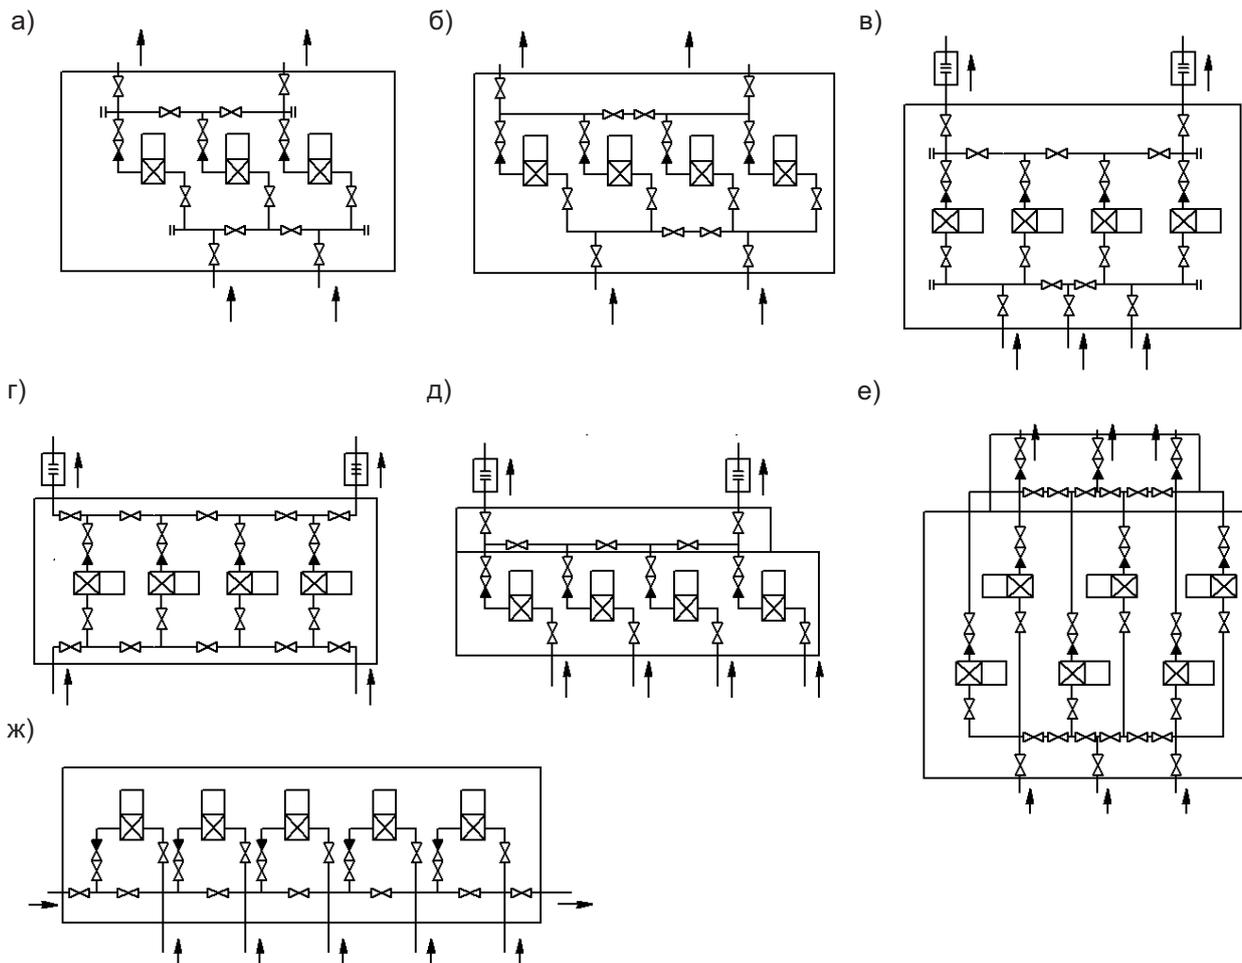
Коллекторные переключения на всасывающих и напорных трубопроводах:
